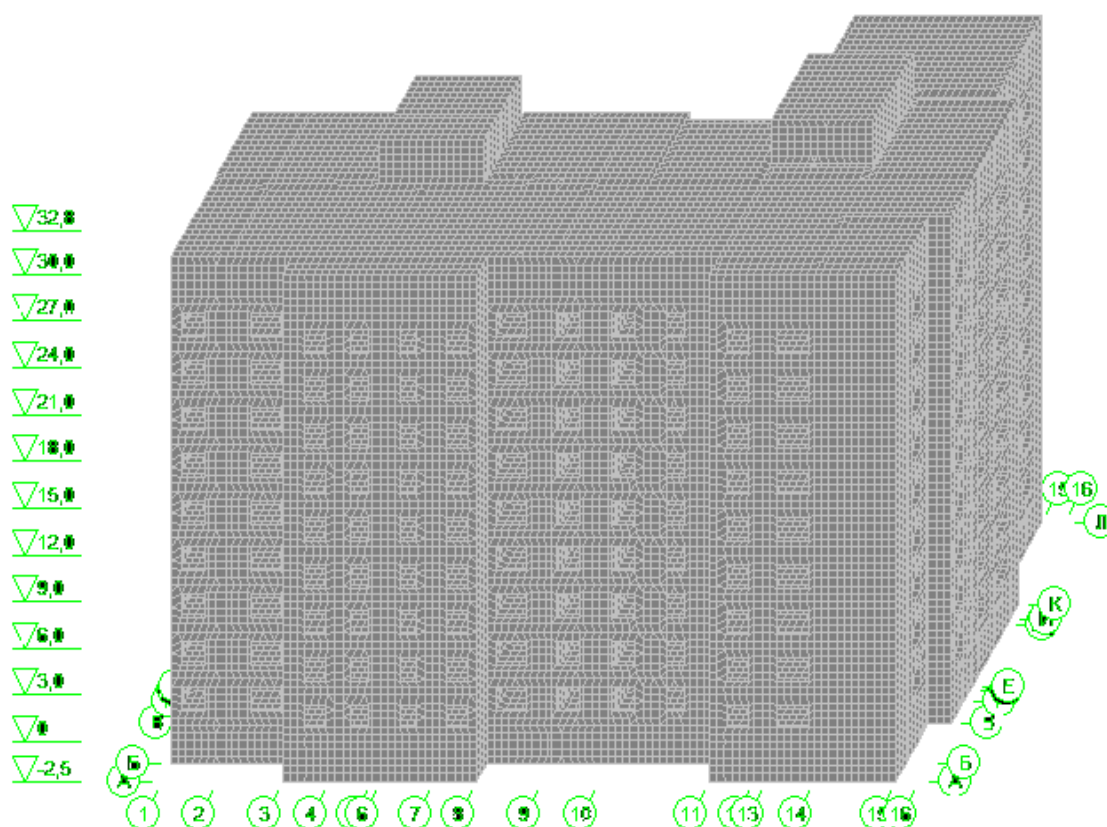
Расчетная схема 9 этажного жилого здания.
